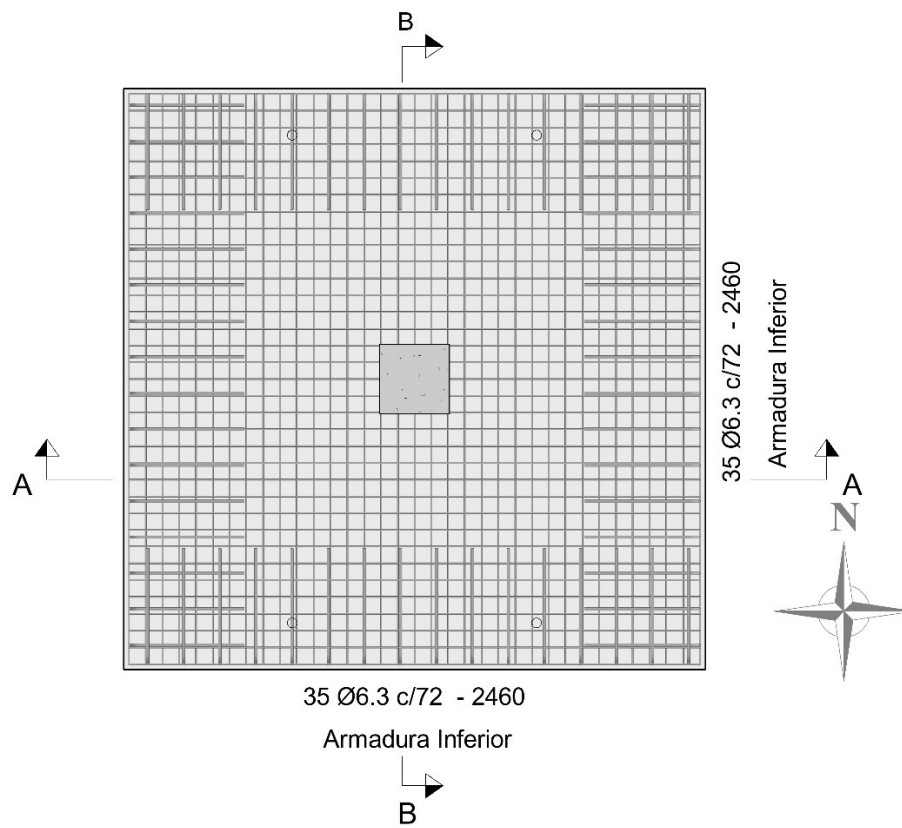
Detalhamento da armadura longitudinal inferior.
